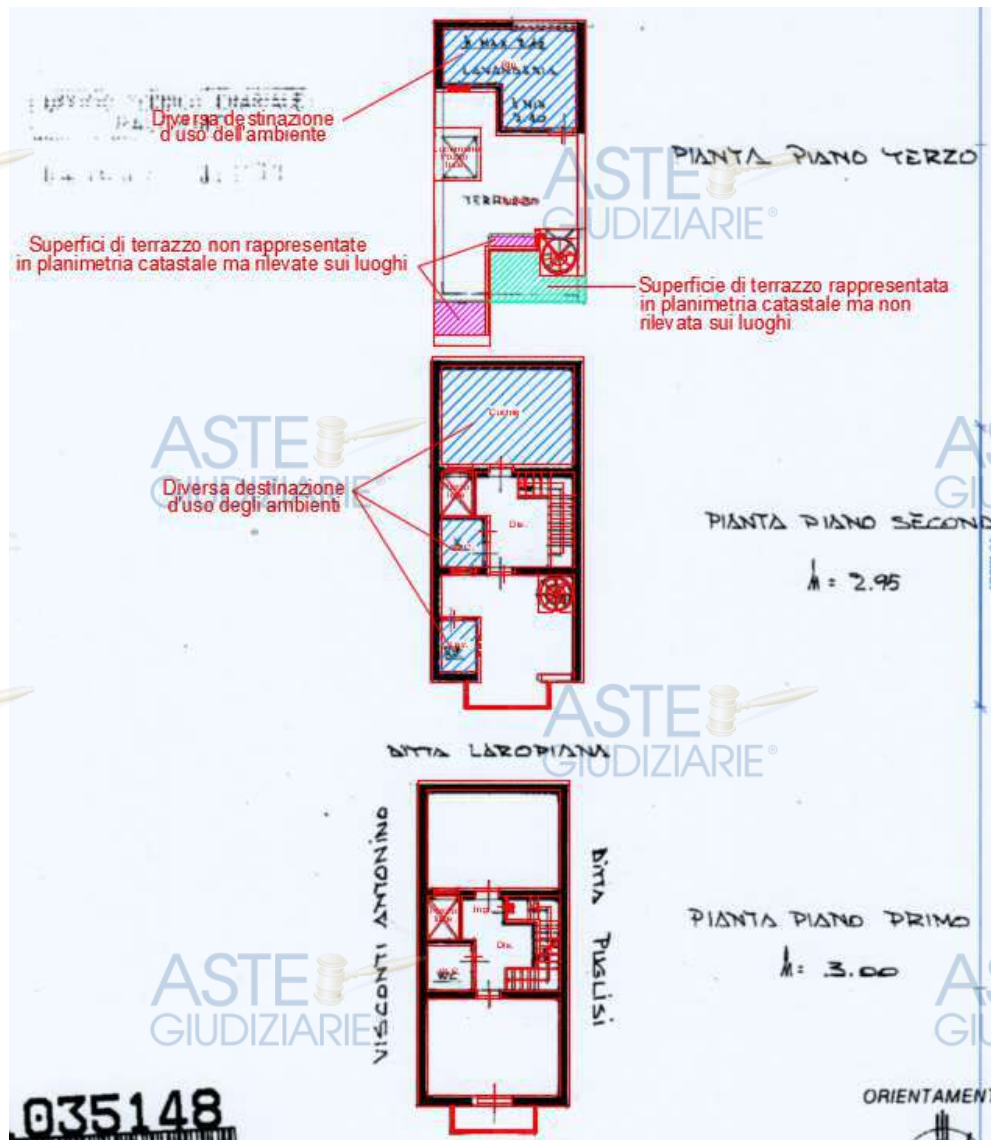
Sovrapposizione della planimetrie di rilievo sulle planimetrie catastali
